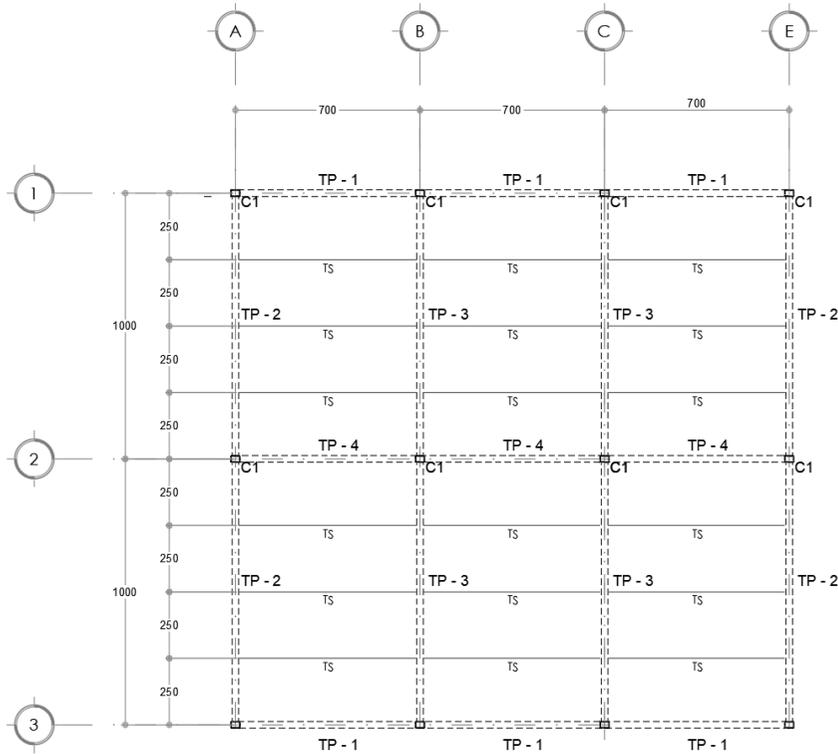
Ubicación de columnas y traveses del edificio A, entre ejes A-E y 1-3
